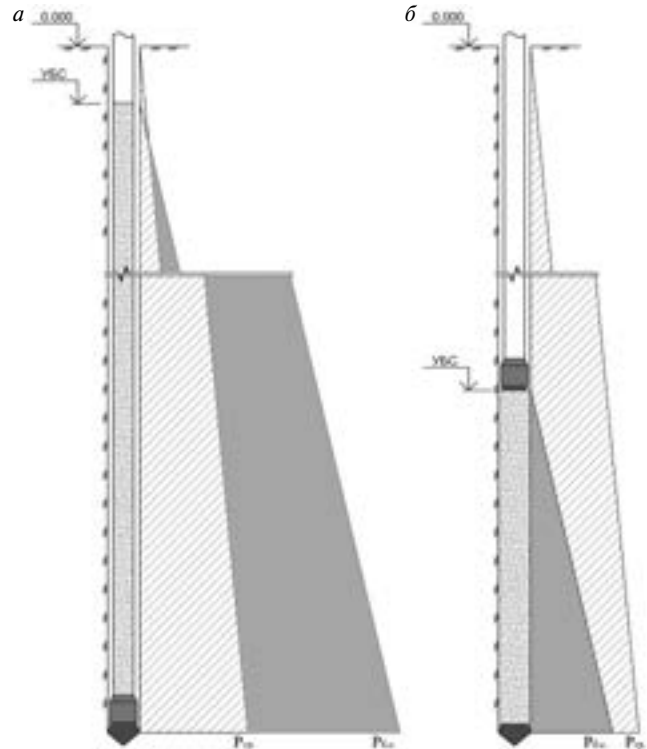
Этапность бетонирования скважины порциями по $1,5 \text{ м}^3$: а – заполнение обсадной трубы бетонной смесью; б – извлечение обсадной трубы; P_p – горизонтальное напряжение от собственного веса грунта; $P_{б.с}$ – гидростатическое давление бетонной смеси; УБС – уровень бетонной смеси в скважине
